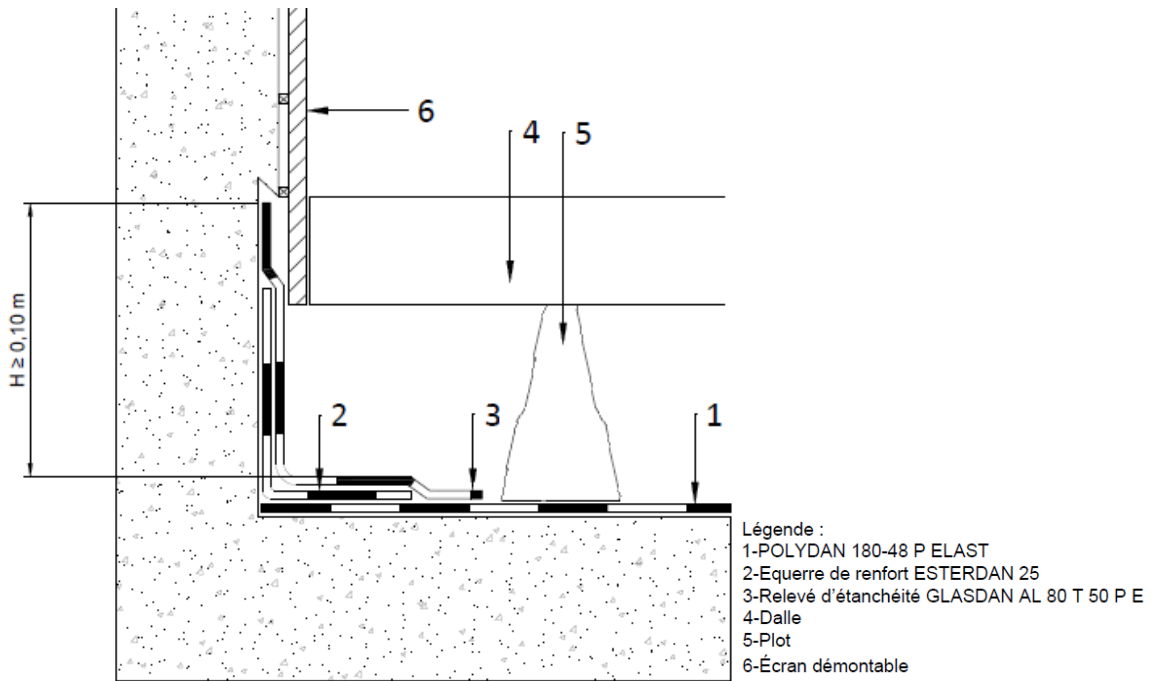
Toitures-terrasses accessibles dalles sur plots
